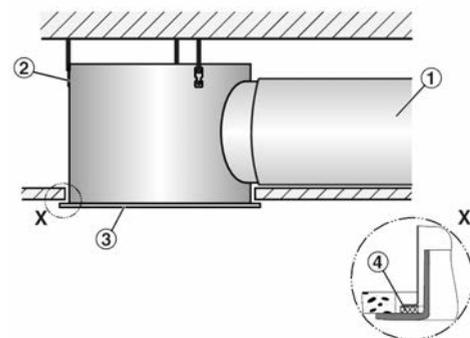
Installazione a filo soffitto con camera di raccordo circolare
